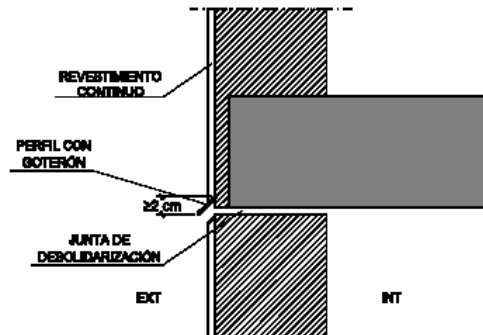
Ejemplos de encuentros de la fachada con los forjados
